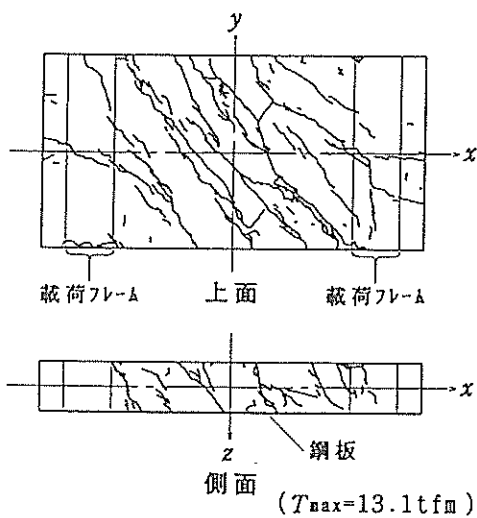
供試体 OS-16-200のひび割れ発生位置
